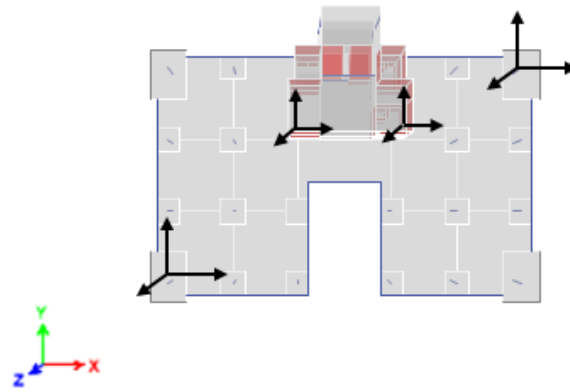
Esquema de ubicación de sensores en la Octava planta y terraza de la estructura.
